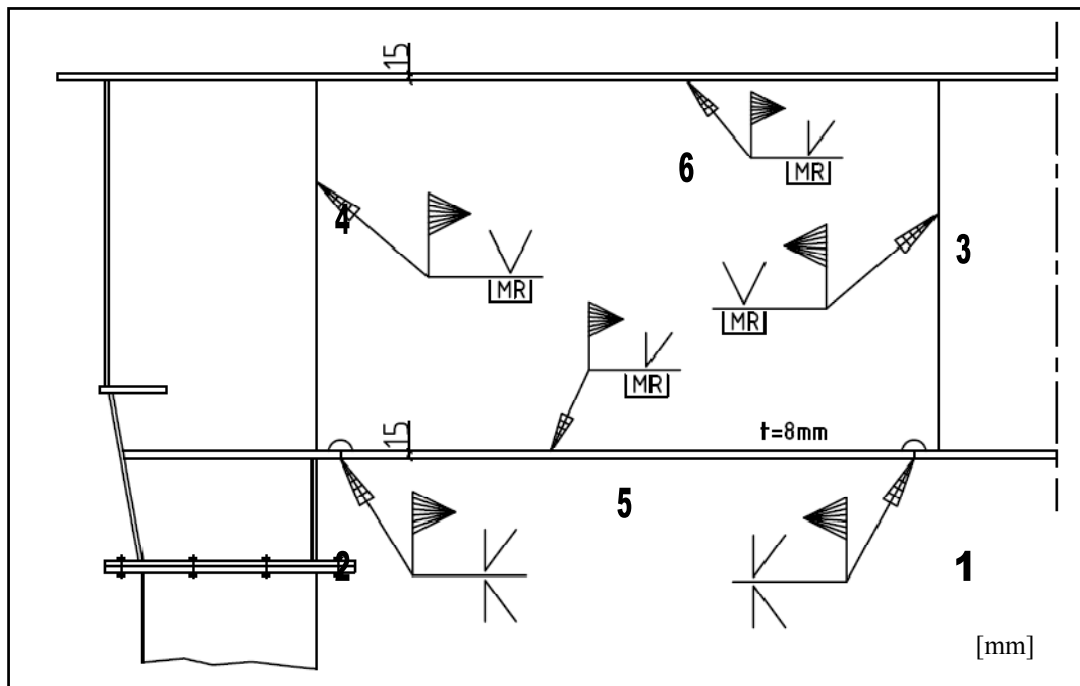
Reparaturschweißung der Stegbleche mit Schweißnahtfolge (1 bis 6)
